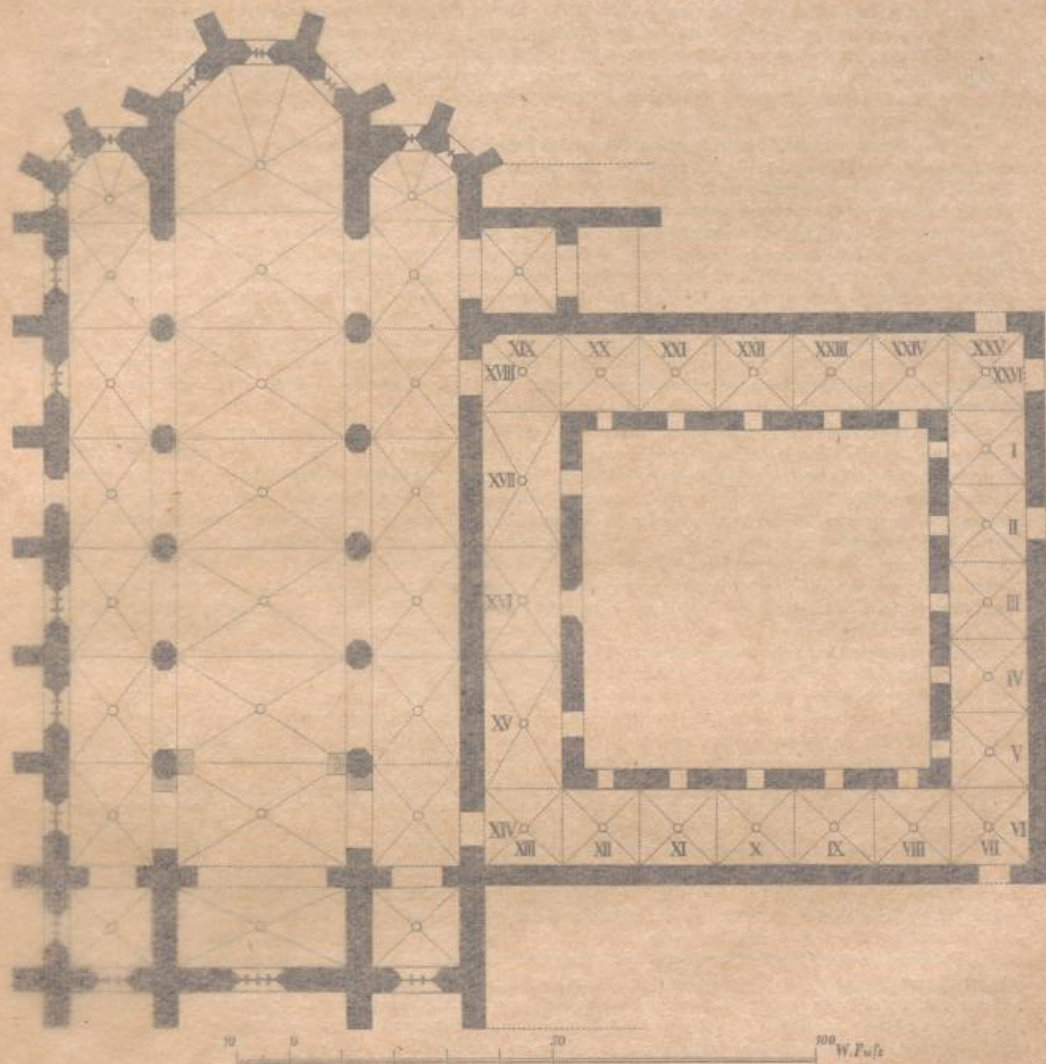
Grundriss der Kirche und des Kreuzganges im Prager Einsiedlerkloster. (Nach Griseb.)
